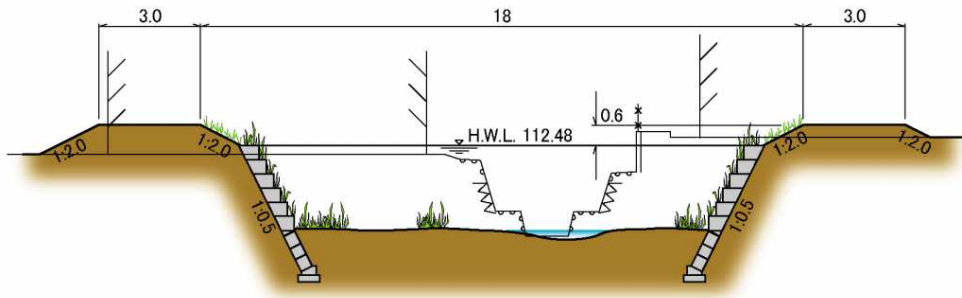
野呂川上流代表断面図 (村山高瀬川合流点から上流 2.6km、単位 : m)
